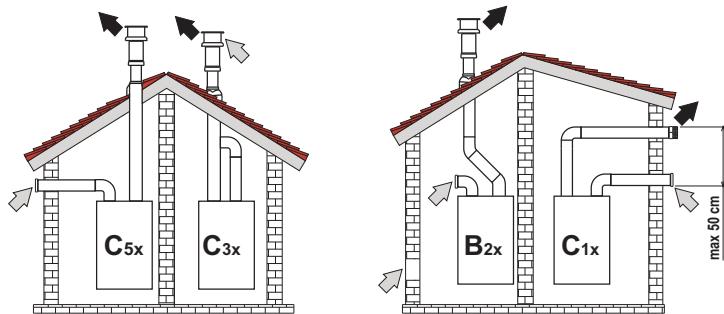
Esempi di collegamento con tubi separati (➡ = Aria / ➡ = Fumi)
